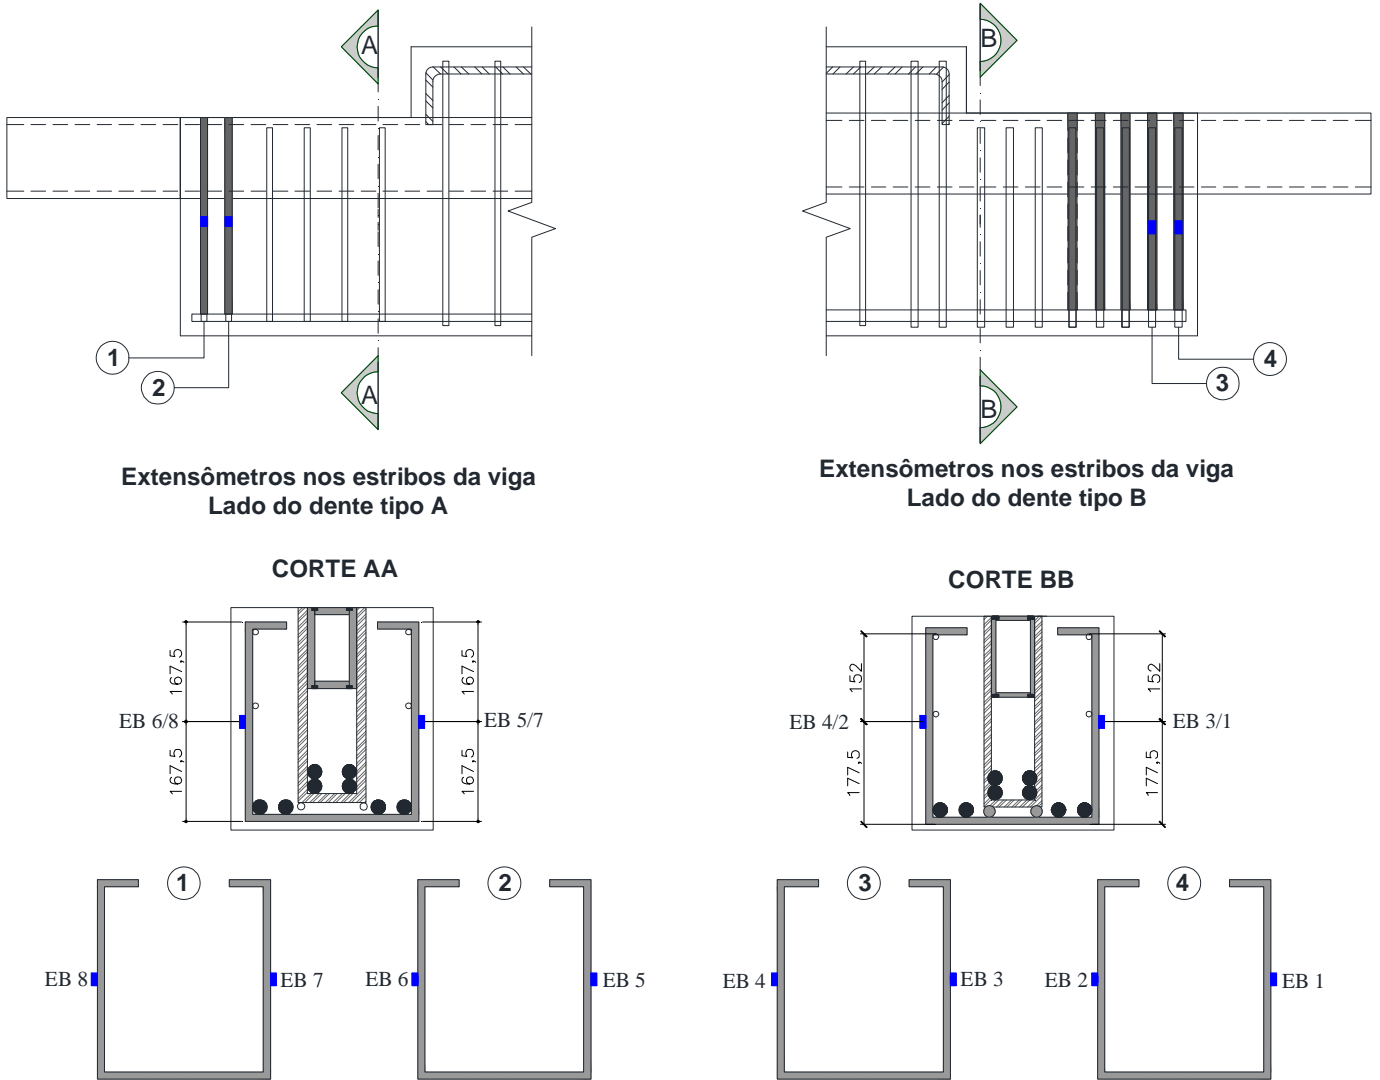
Posicionamento dos extensômetros nos estribos da viga pré-moldada.
